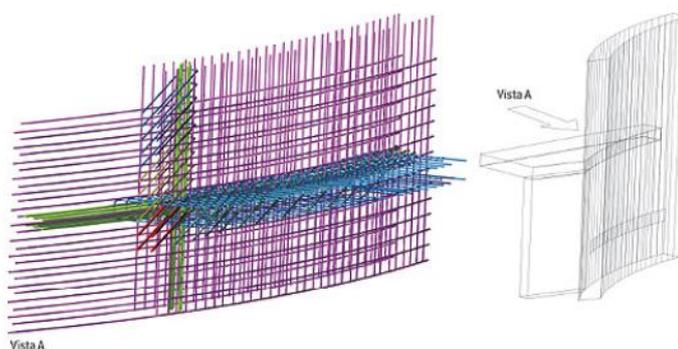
Projeção em 3D usada para garantir a execução da área mais densamente armada do edifício. Fonte: Revista Techné.
